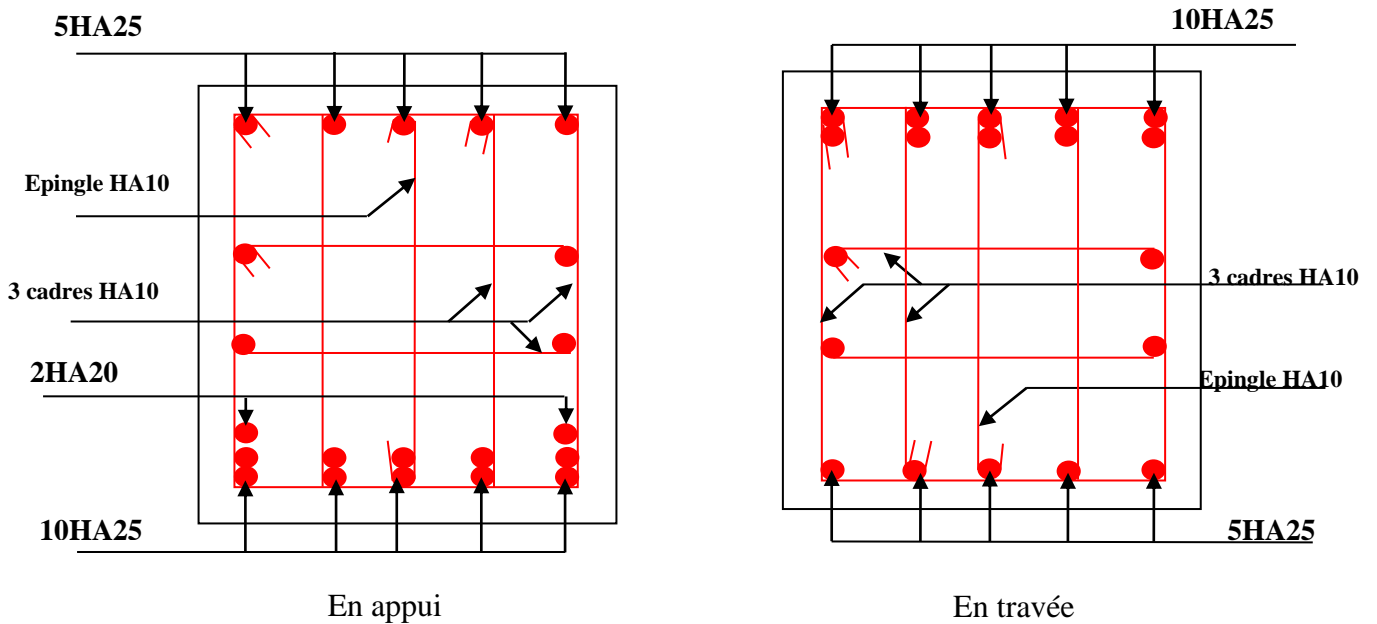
Schéma de ferrailage des nervures sens y-y
